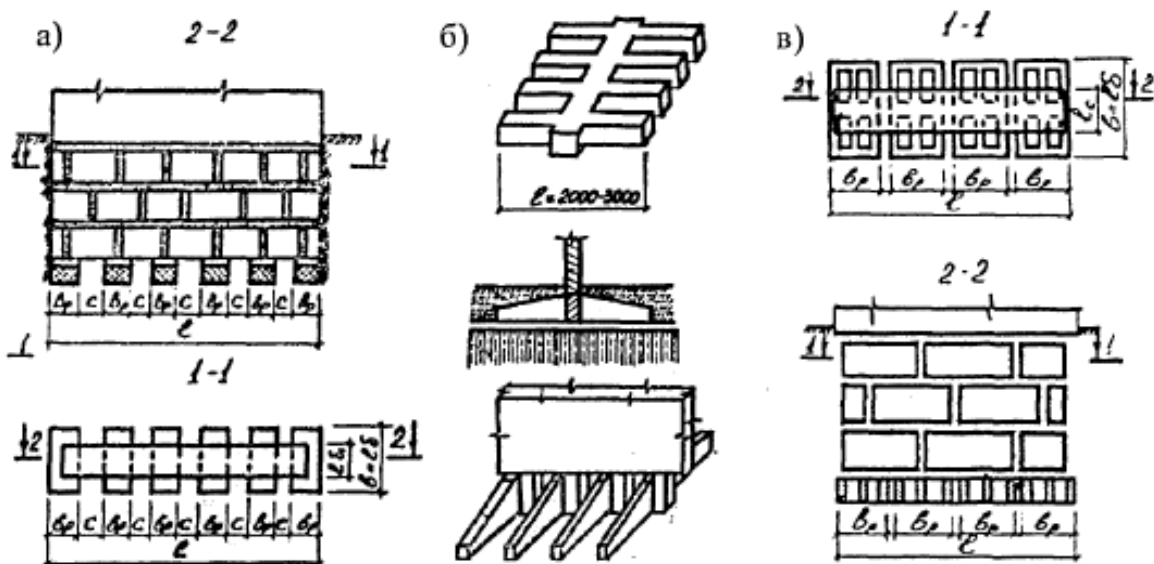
Деякі види переривчастих фундаментів: а-стрічковий переривчастий фундамент; б- переривчато-шпальний фундамент; в - переривчато-ґратчастий фундамент [1,3]
